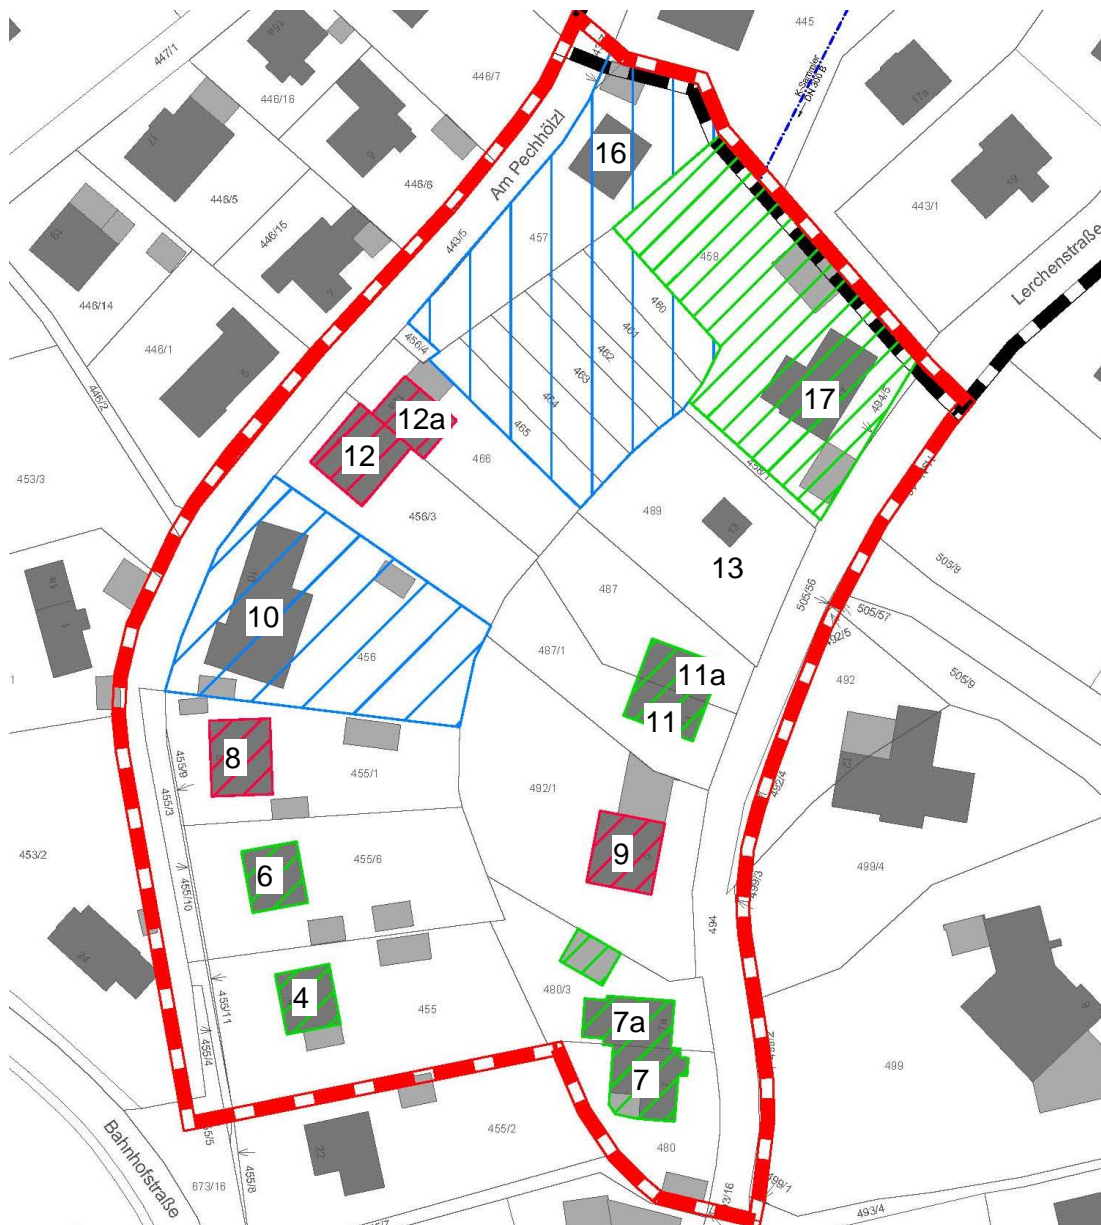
Lageplan Entwässerungsarten Grundstücke, Angaben aus Gebührensplitting
